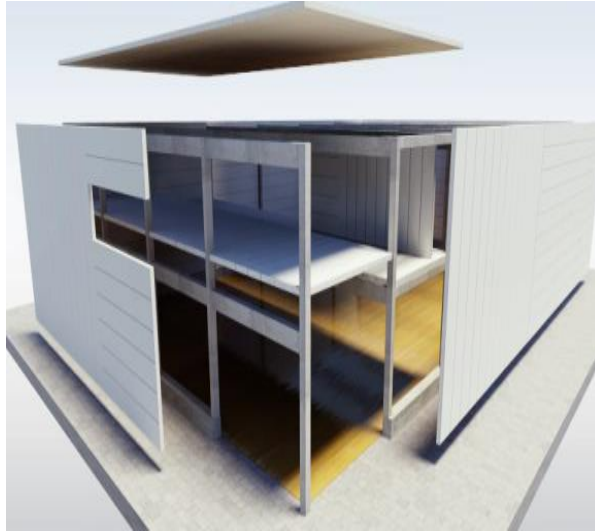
Utilización de panel losa y panel muro para edificaciones industriales
